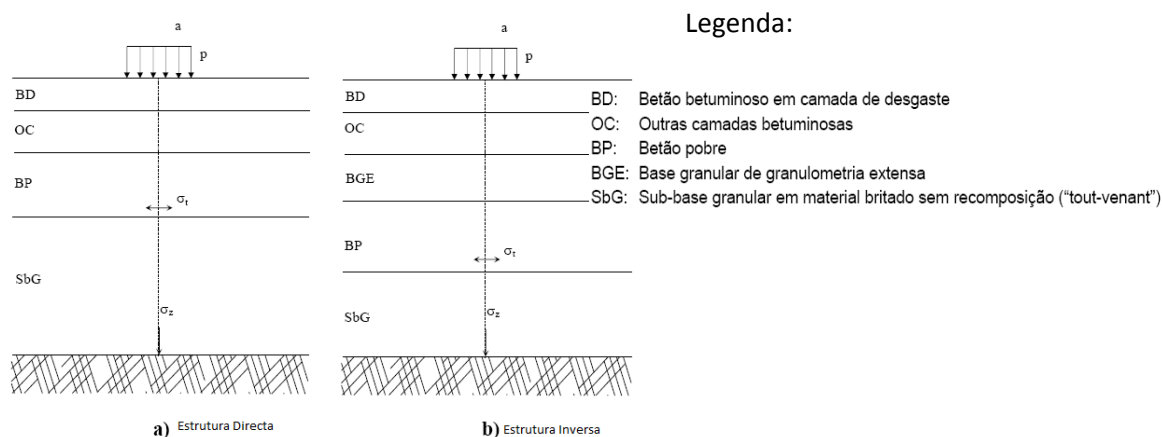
Estrutura possível para uma solução de pavimento semi-rígido (Fonte: Paulo Fonseca)
